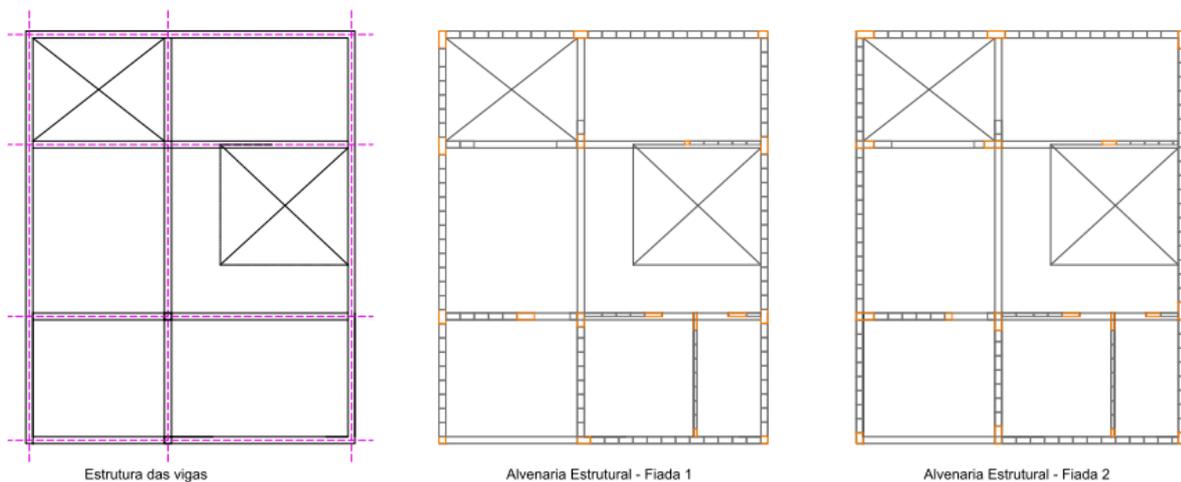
Representação esquemática em planta do sistema construtivo de alvenaria estrutural
